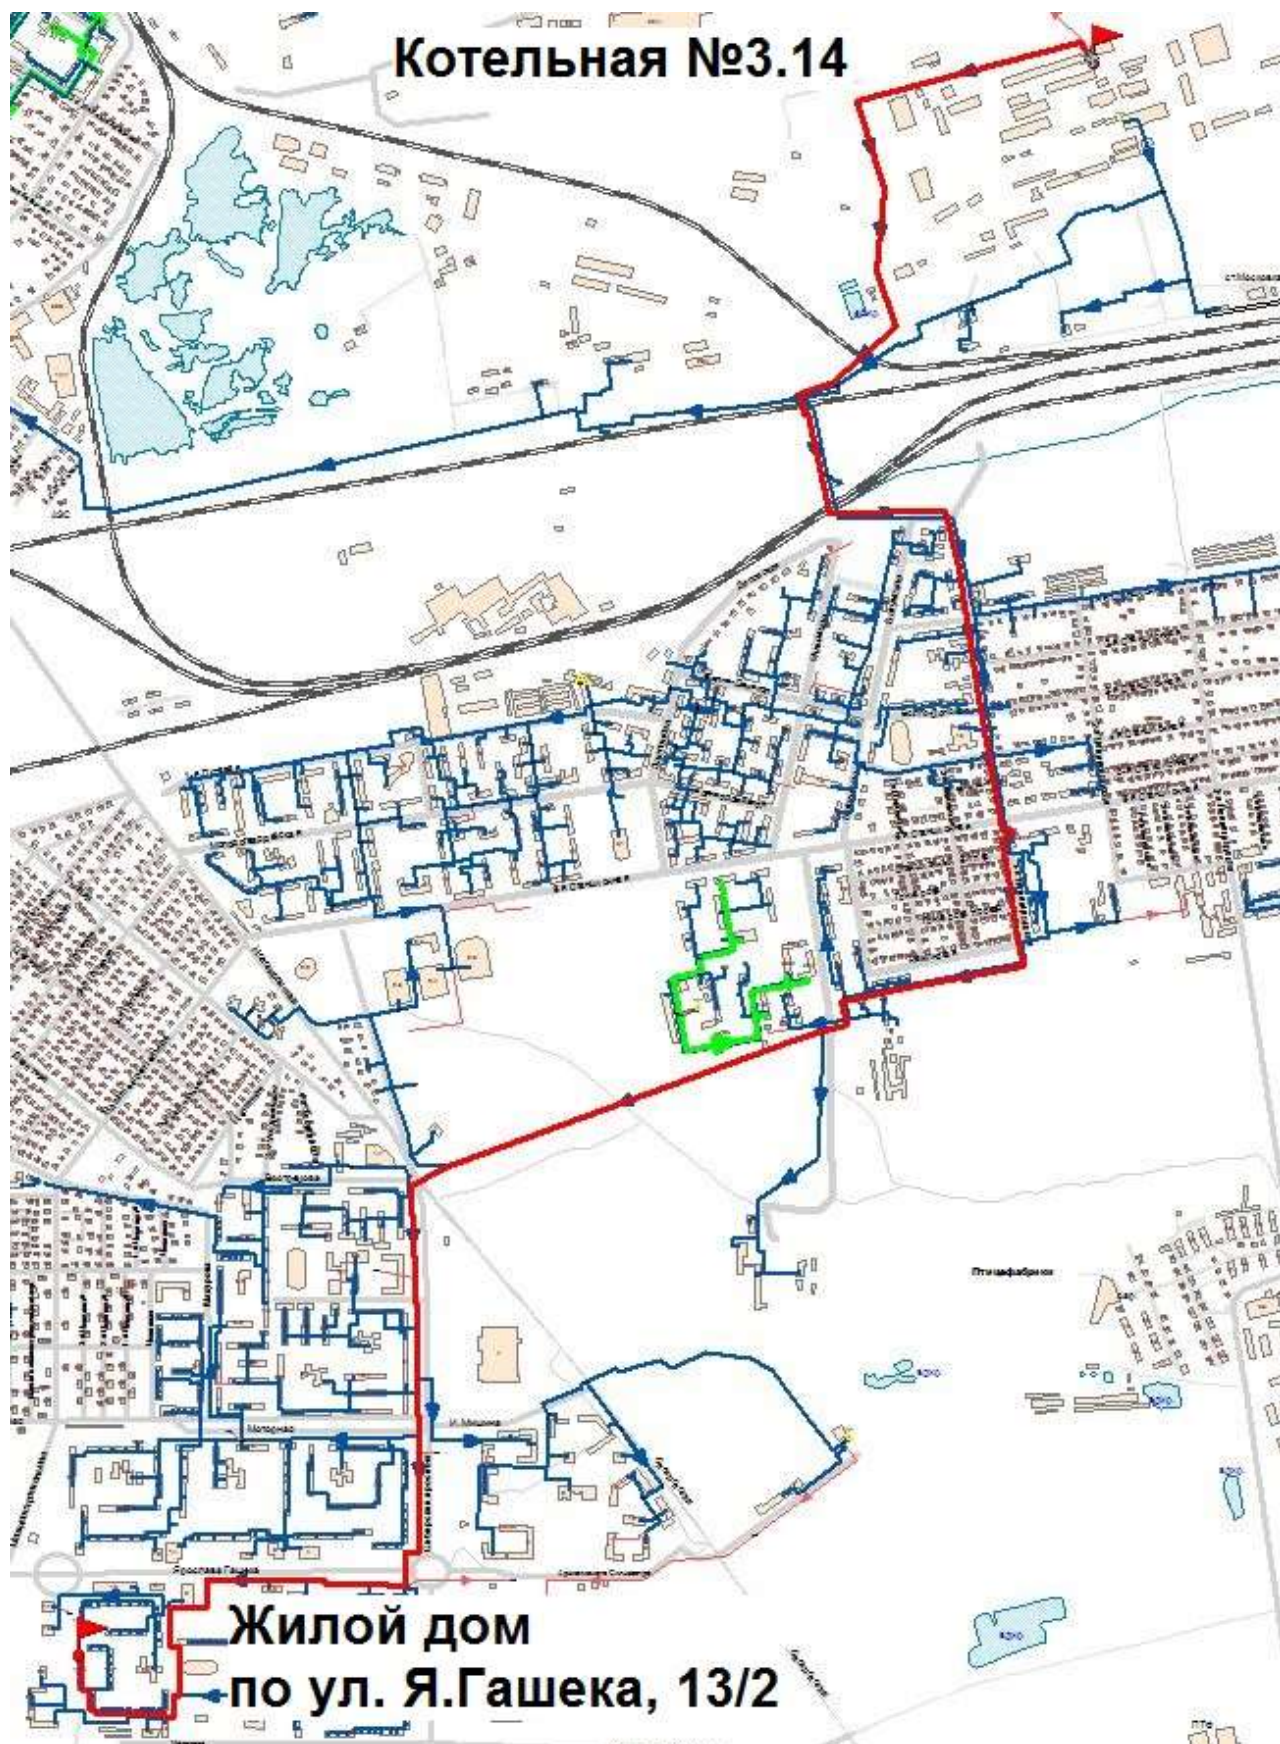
Трассировка теплопровода от Котельной 3.14 до жилого дома по ул. Я. Гашека, 13/2
